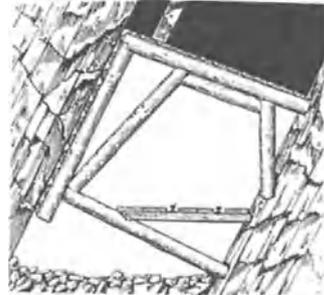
Schalholzzimmerung mit Sprengwerk über offenem Abbaubauraum.
